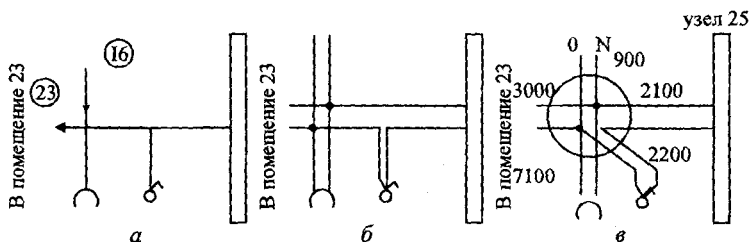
Схемы соединений осветительной электропроводки в узле № 25:
